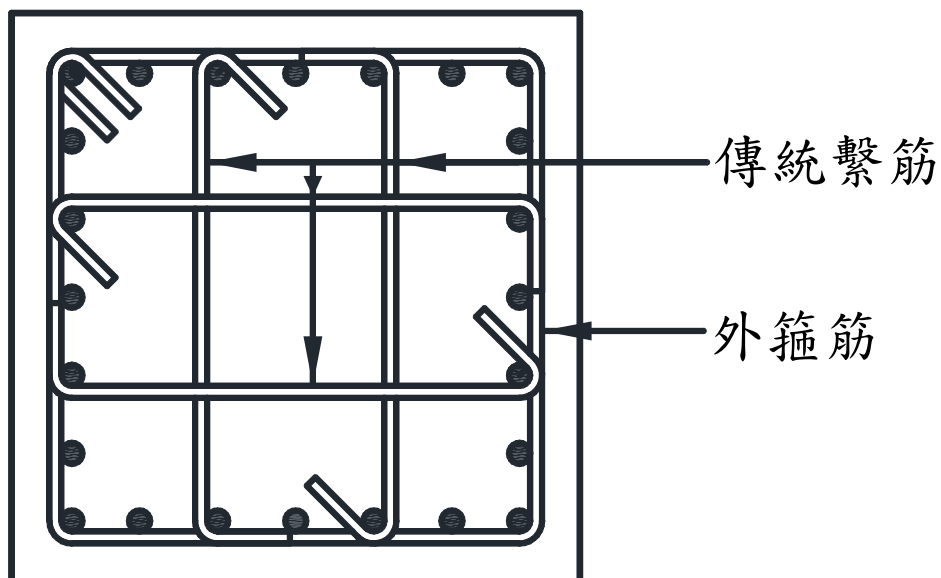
鋼筋混凝土耐震柱的橫向鋼筋配置示意圖
